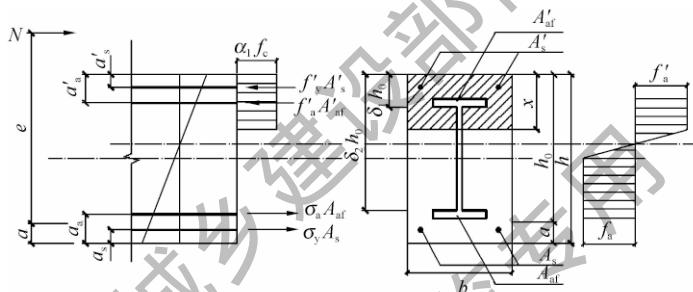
偏心受压框架柱和转换柱的承载力计算参数示意
